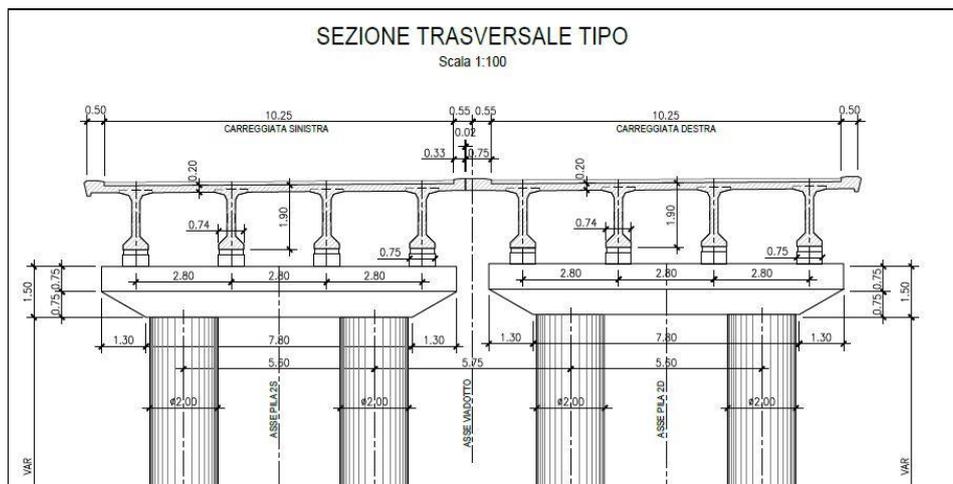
Sezione impalcato viadotto Aterno – Stato attuale
